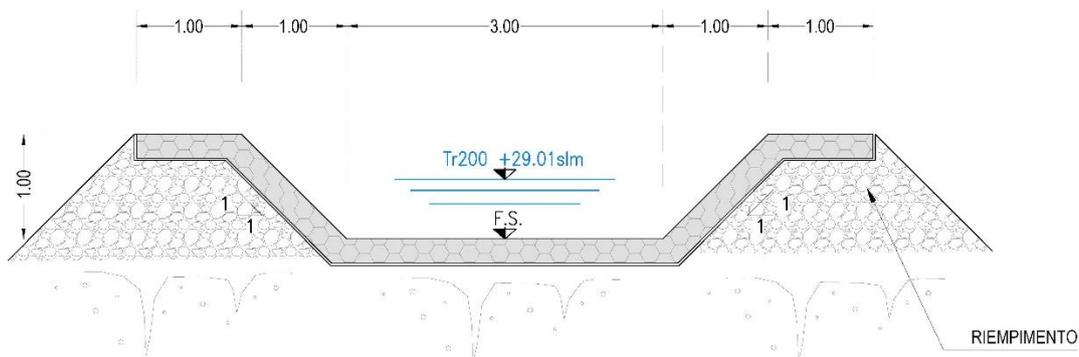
Sezione tipo del canale rivestito in materassi tipo reno.
